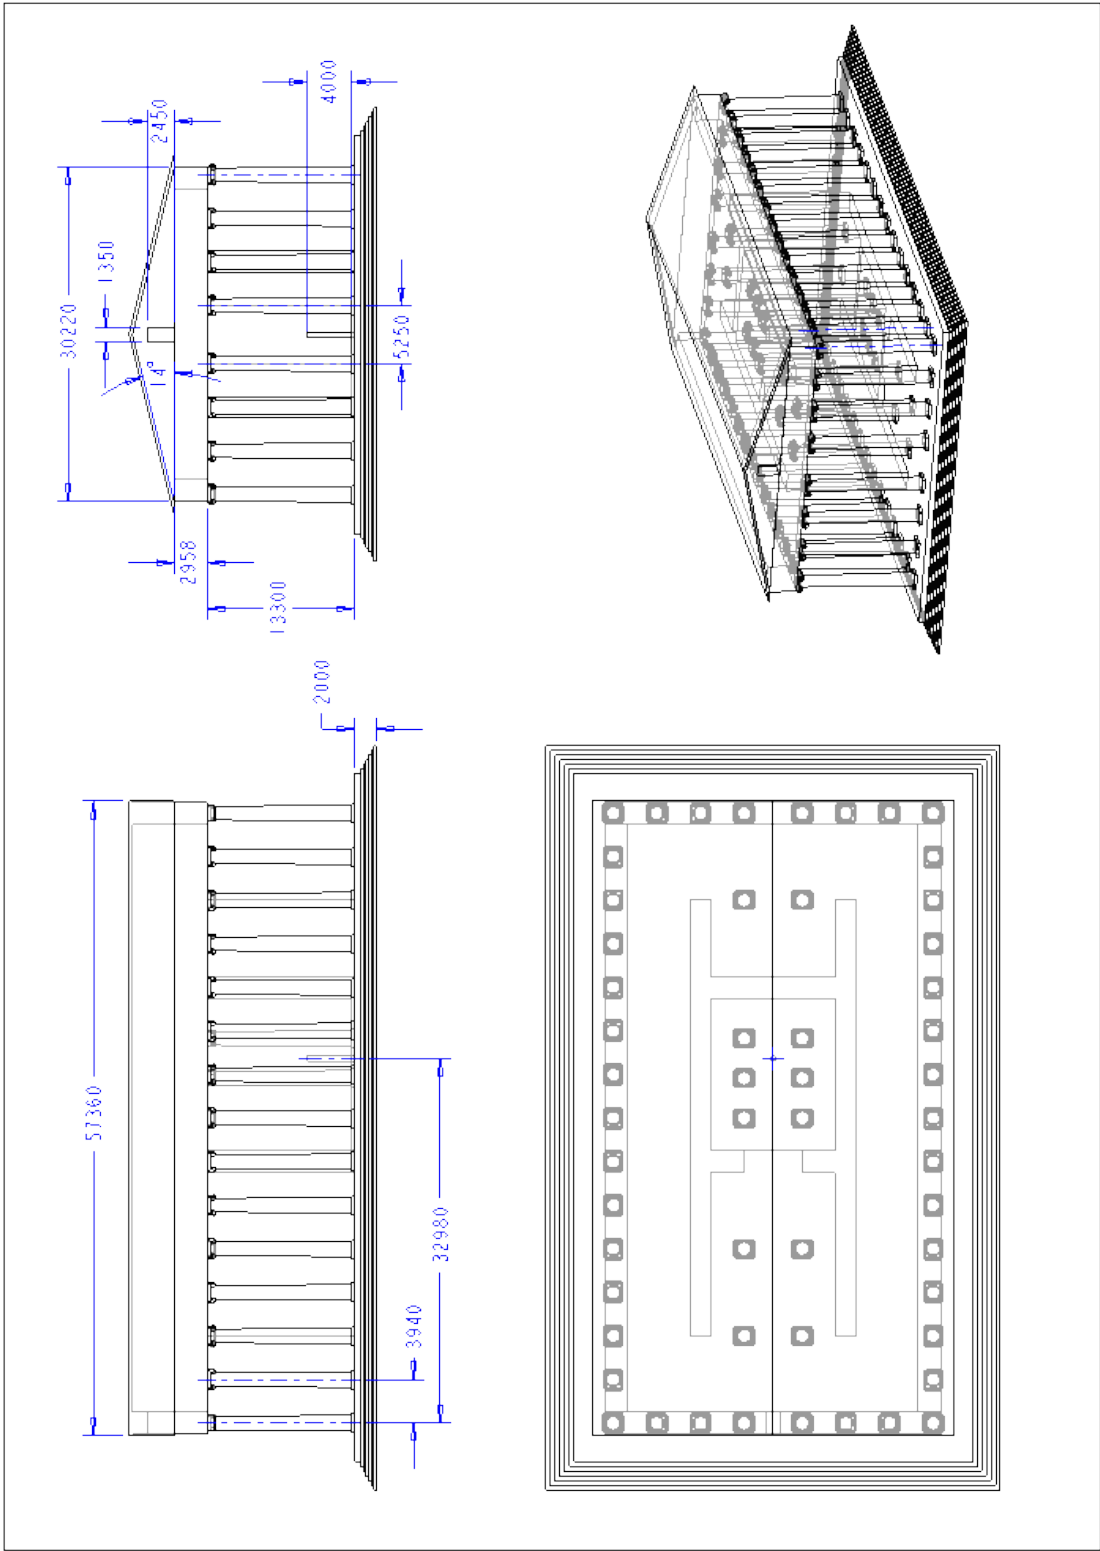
Grundriss und Aufriss des Artemisions mit den verwendeten Abmessungen.
